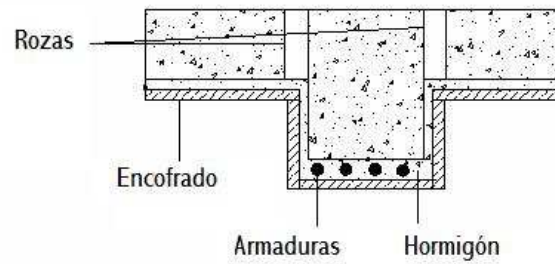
Consolidación de vigas mediante hormigón armado
